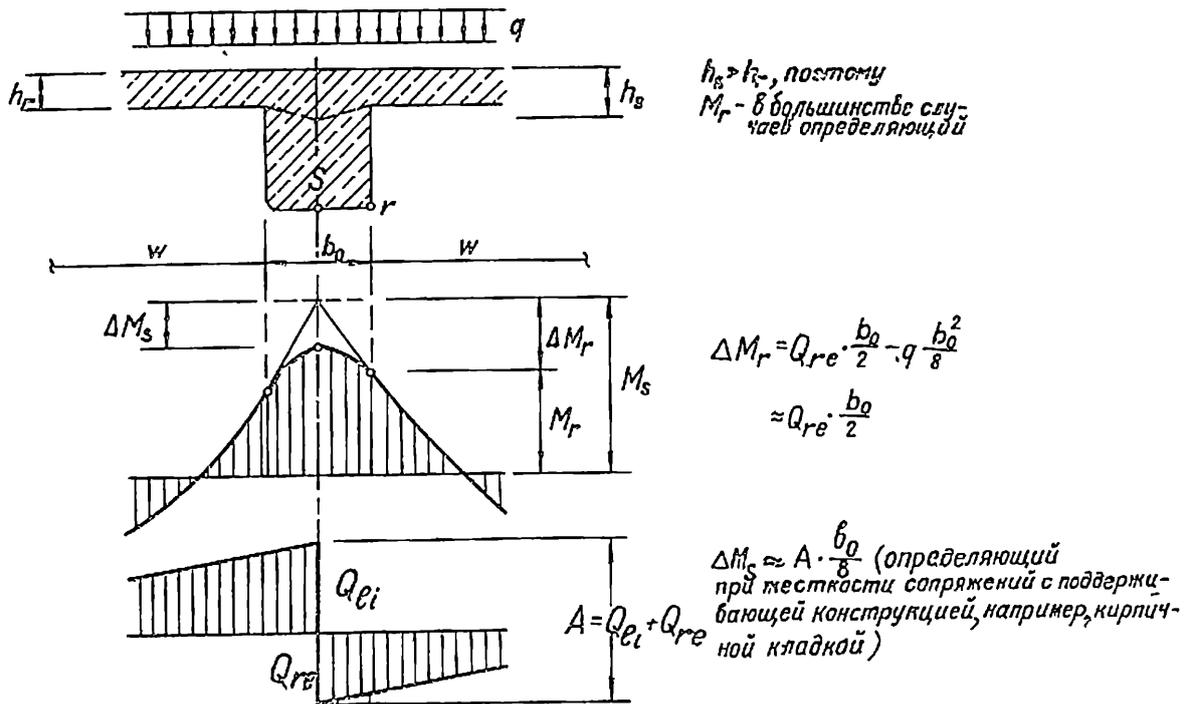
6. Эпюра моментов по ширине b_0 и габаритные моменты M_z , определяющие подбор верхней арматуры
